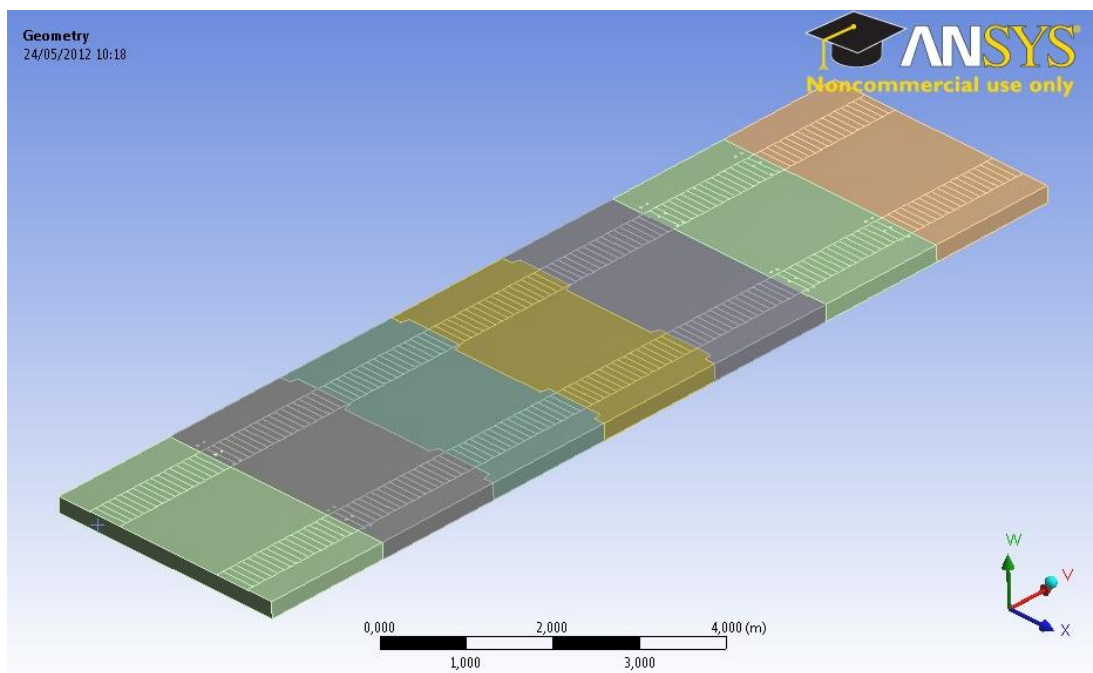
Sistema machihembrado de paneles prefabricados.
